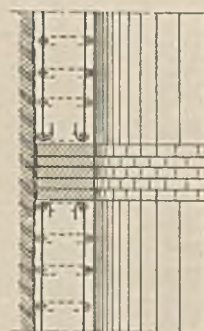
Schachtausbau in Eisenbeton mit Quetschfugen.
